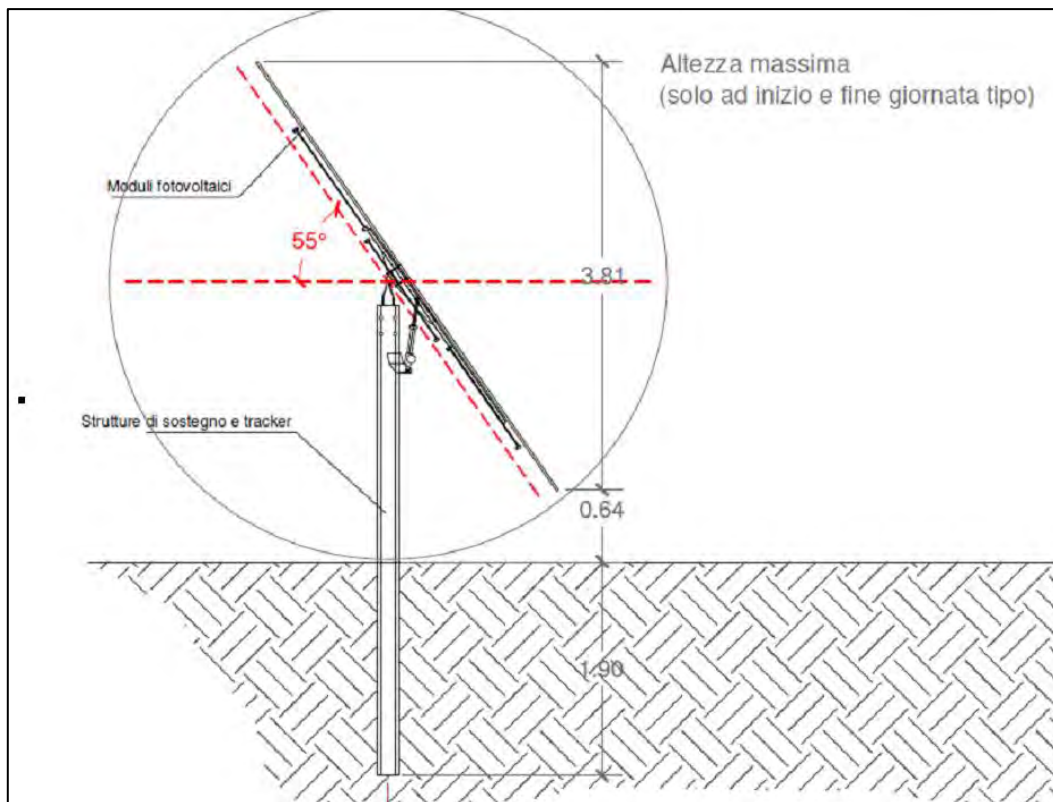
indicazione dell'altezza massima della struttura in movimento
